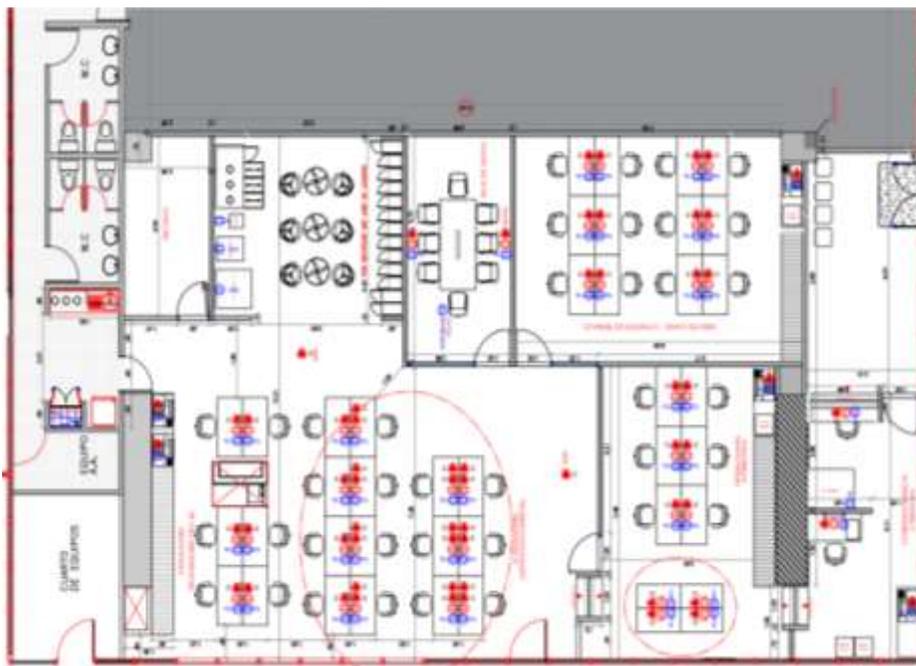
Plano arquitectónico. Fuente: Davivienda Área infraestructura
